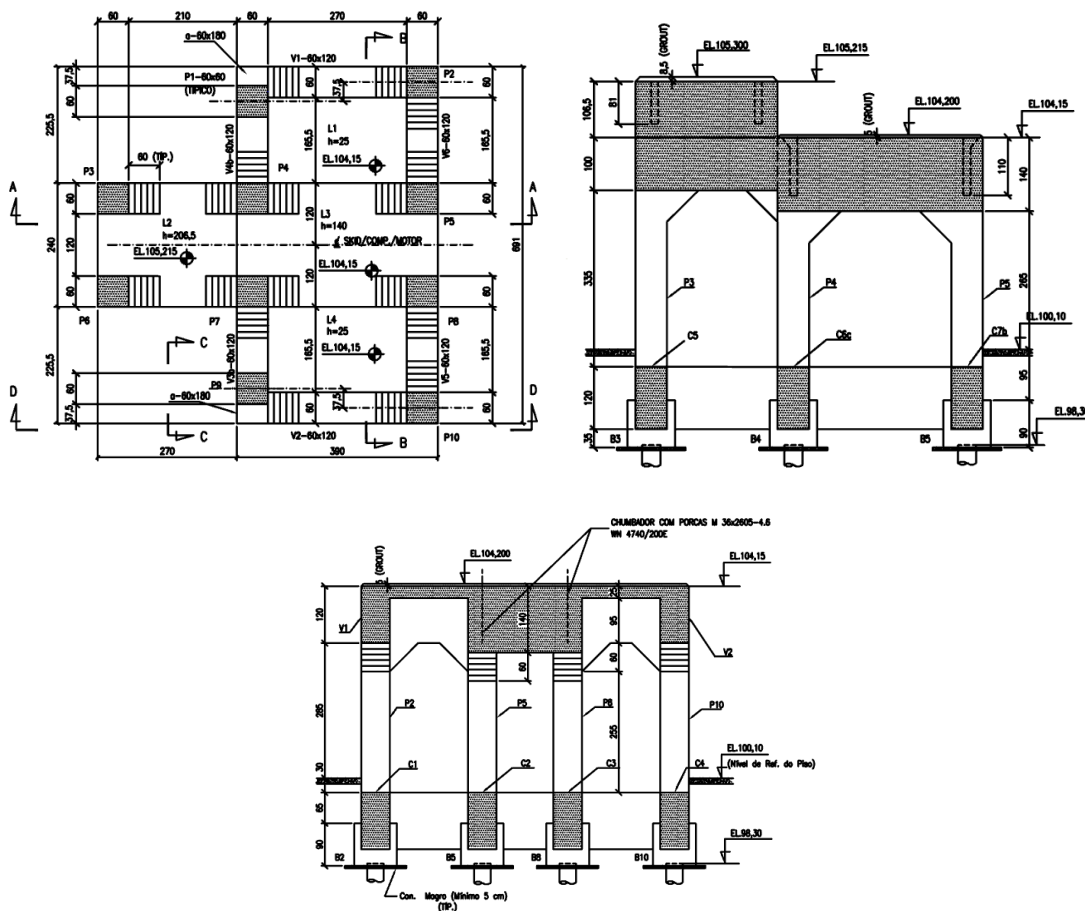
Planta e cortes da estrutura de suporte do compressor
